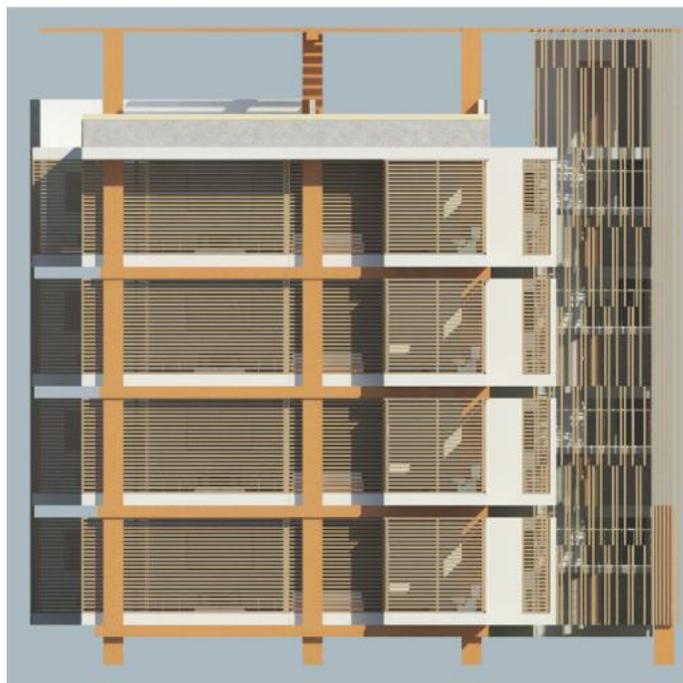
3D Fachada lateral izquierda Apartamentos sub-oficiales casados
